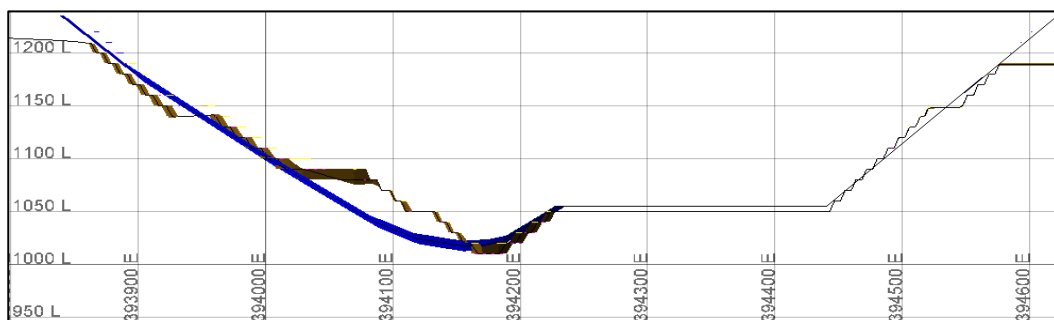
LG2Y Fase 2 - Vista en sección - Corte secundario E-O N7132200
